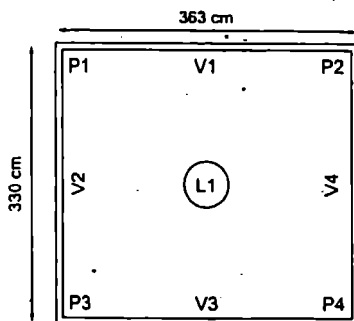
Planta do pavimento para análise do comportamento de laje pré-moldada.
